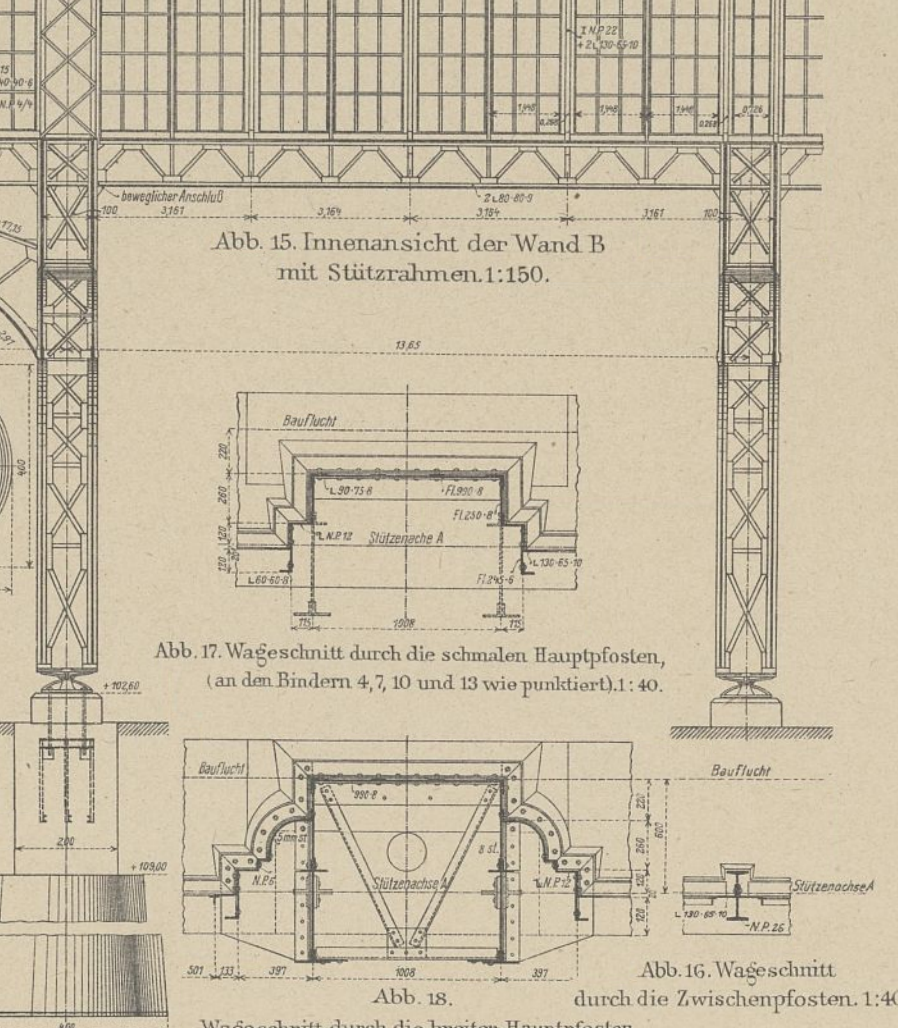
Innenansicht der Wand B mit Stützrahmen. 1:150.
